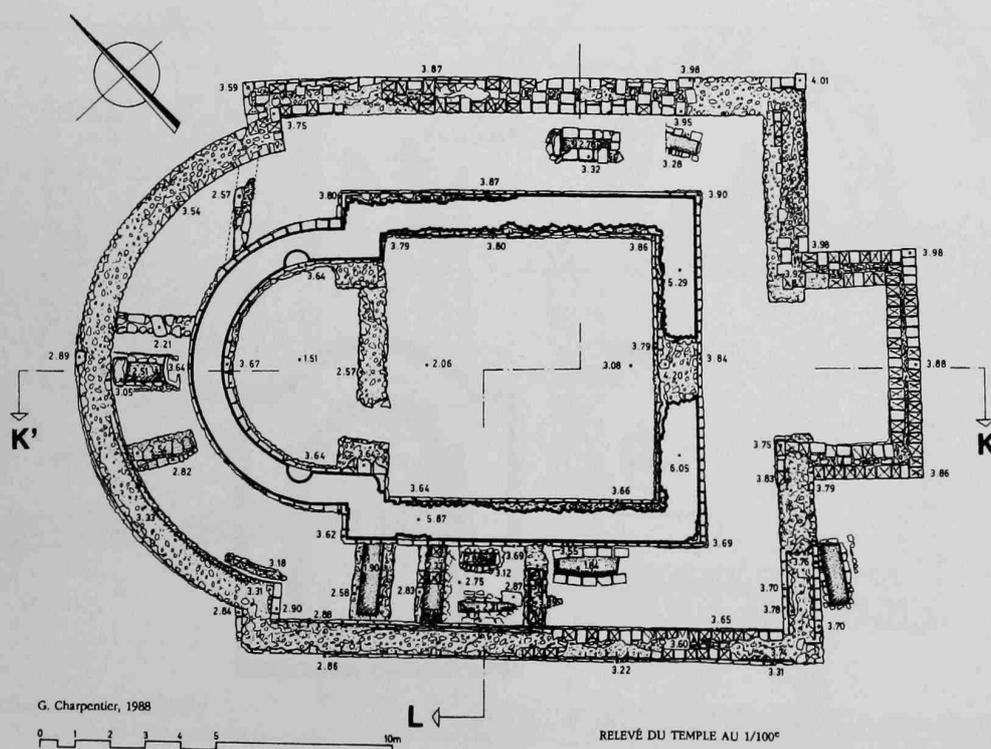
Planta do edifício da construção central de São Cucufate, elaborada por G. Charpentier.
